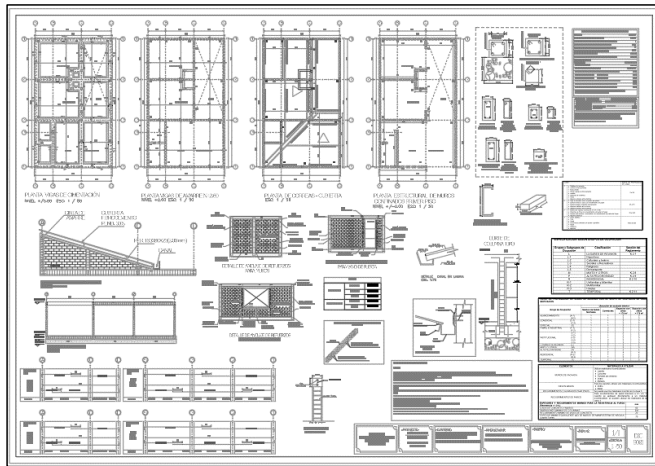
Planta estructural de vigas de cimentación y vigas de amarre.
